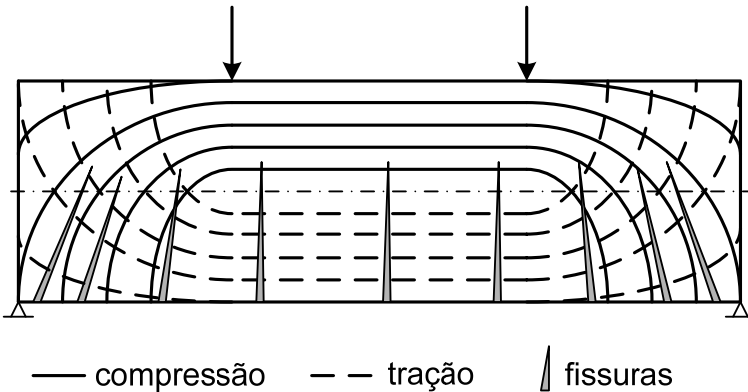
Trajetórias das tensões principais e orientação das fissuras em uma viga fletida
